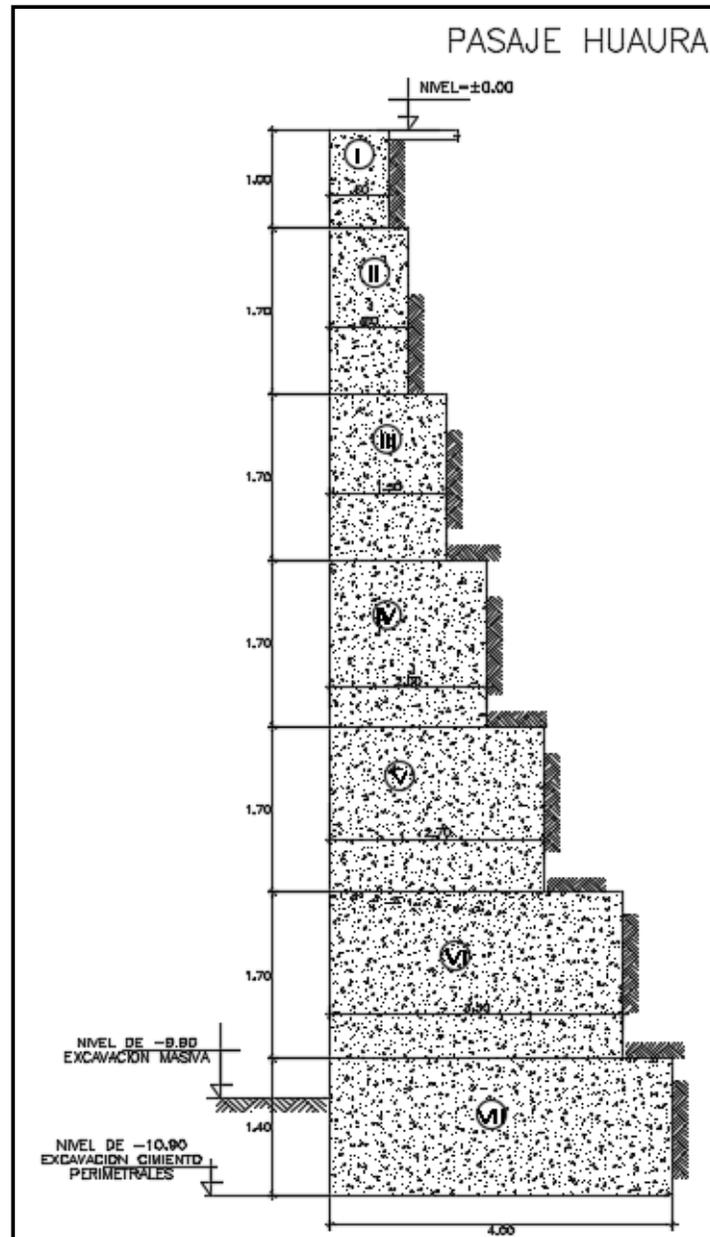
Corte típico de calzada obra 2: Edificio Crossland.
